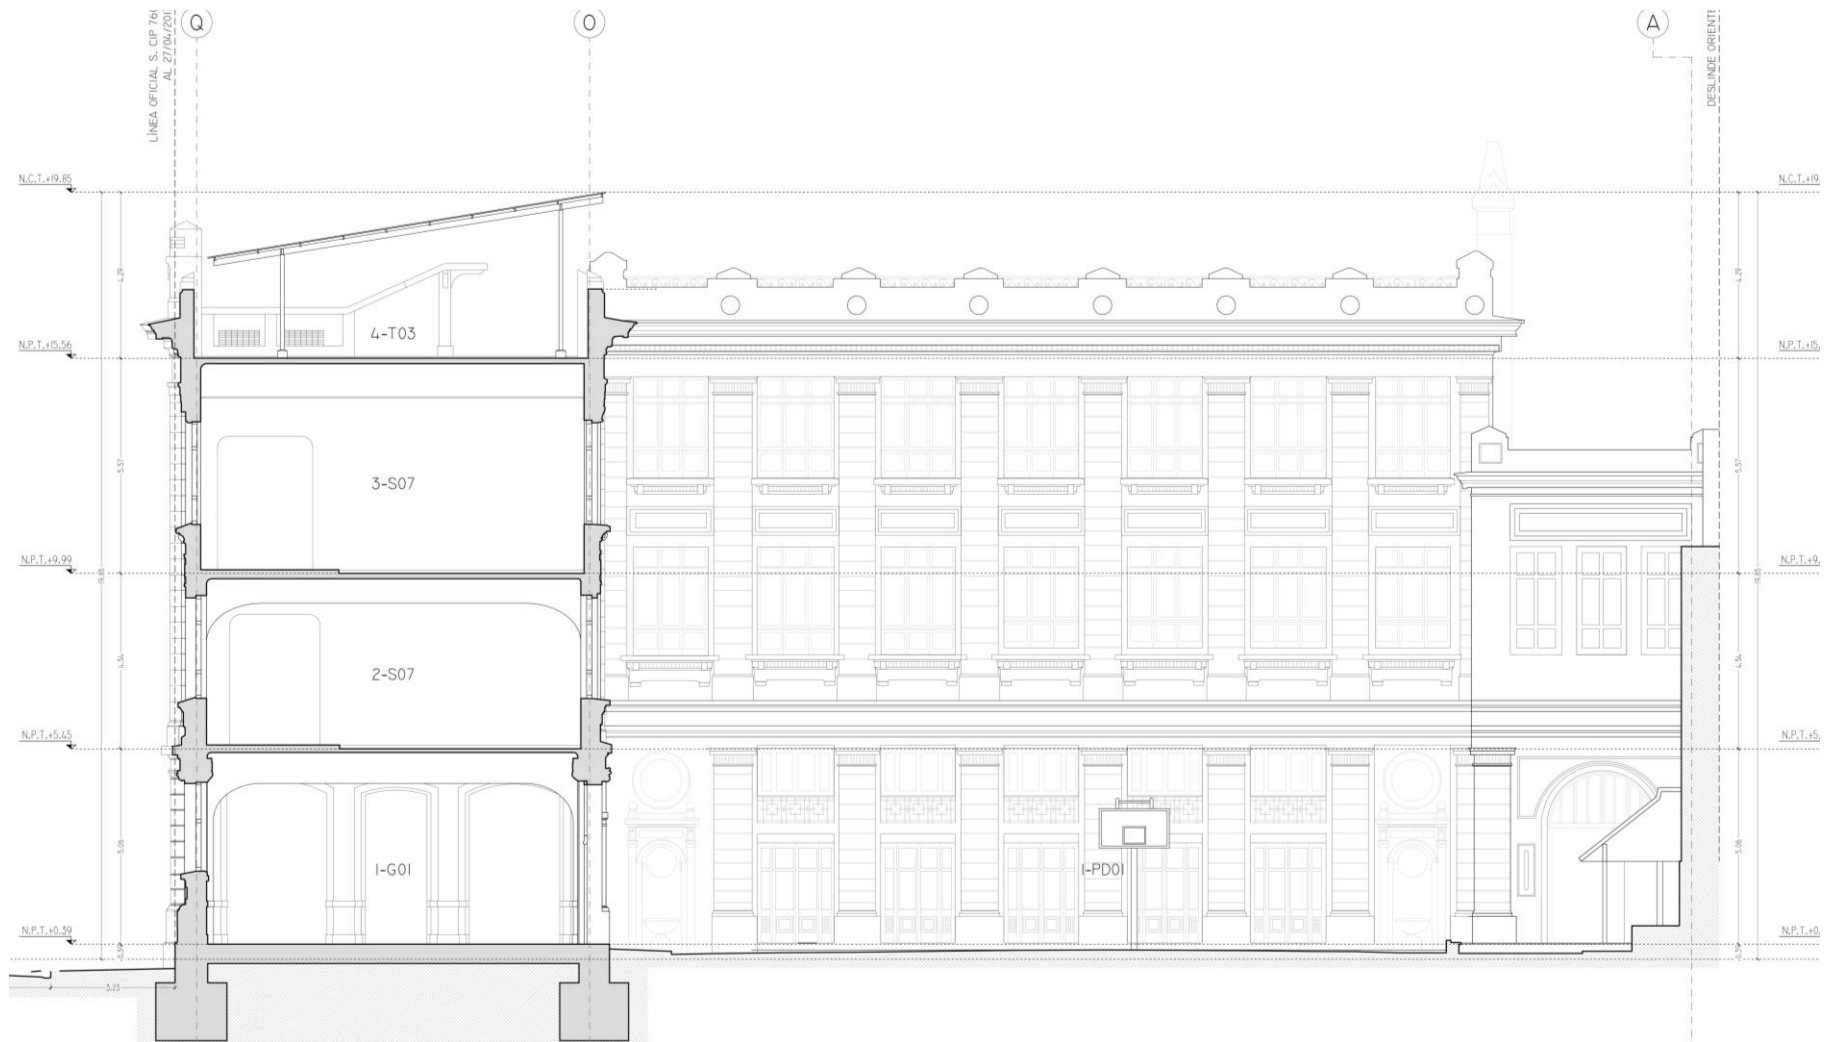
Elevación Fachada Pedro Montt Interior previo a la intervención. Fuente: Cyparq.
